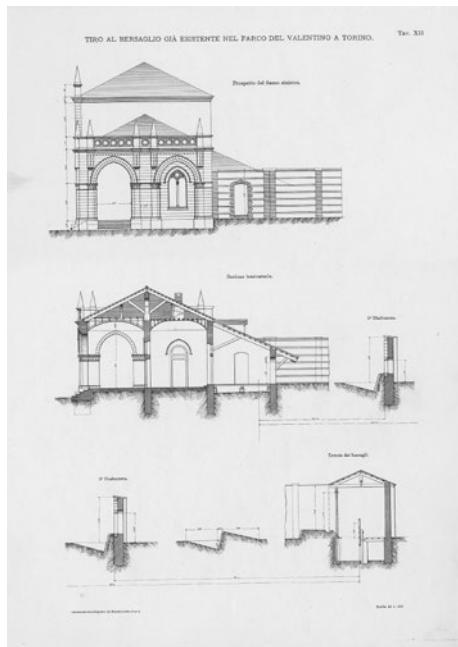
Tiro al Bersaglio già esistente nel Parco del Valentino a Torino. Prospetto del fianco sinistro e Sezione trasversale, con la tettoia dei bersagli (ASCT, Collezione Simeom, D 753, tav. XII).
